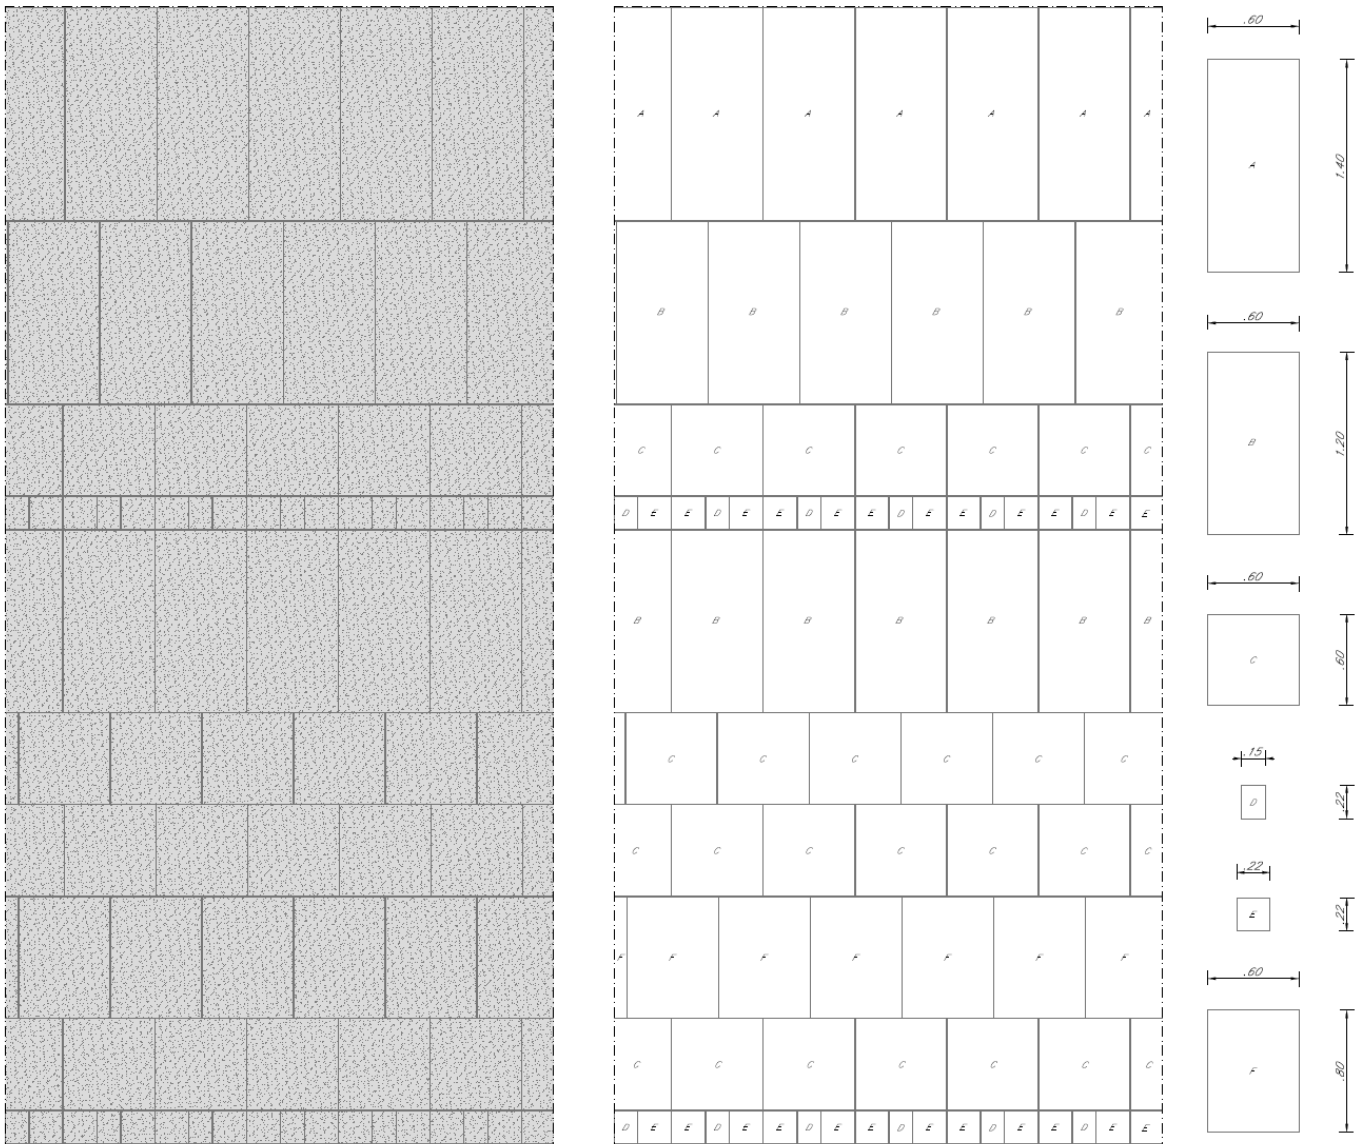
Schema di posa e di orditura pavimentazione sottopasso
